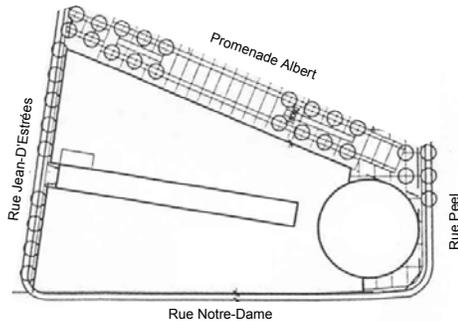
Implantation et alignement d'après l'Annexe B du règlement 01-316, planche A-003 (Plan d'architecture)
